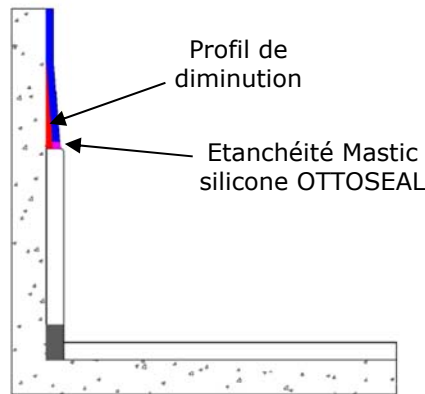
Remontée en plinthe sur sol PVC : soudage/joint avec profil de diminution ou enduit (uniquement pièces sèches)
